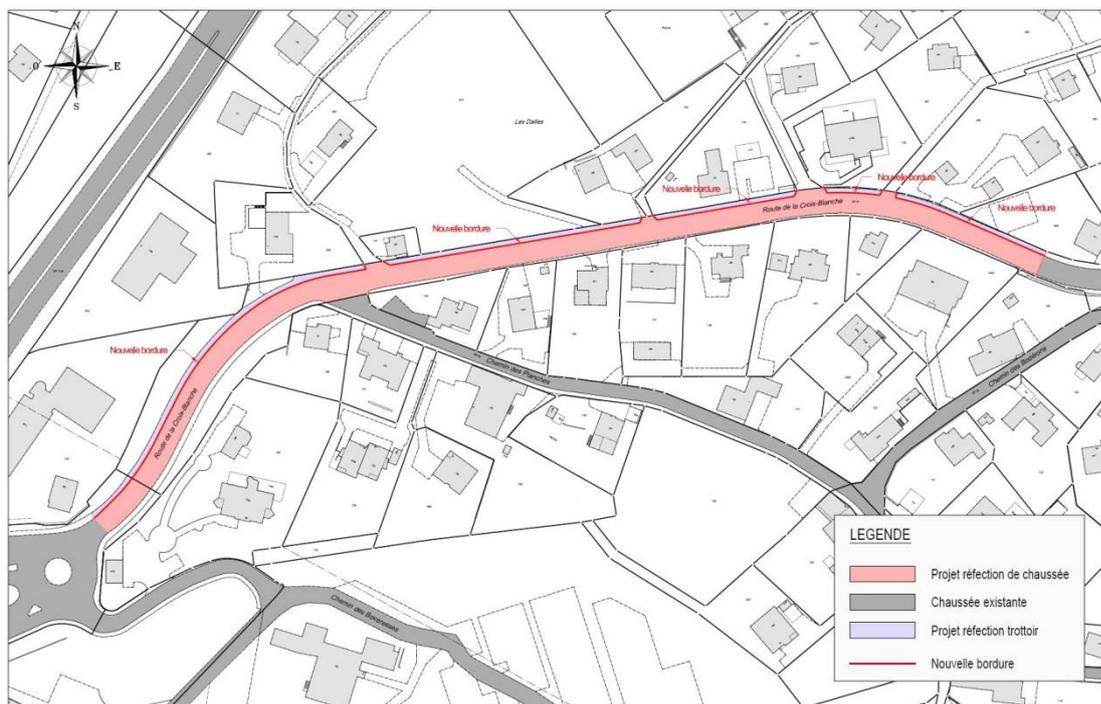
Plan des travaux sur la Rte de la Croix-Blanche
